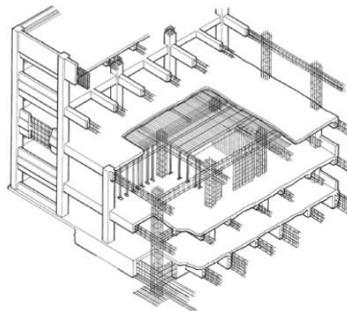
Ejemplo de estructura de marco rígido de concreto reforzado (tekkotsu konkuritokozo)
